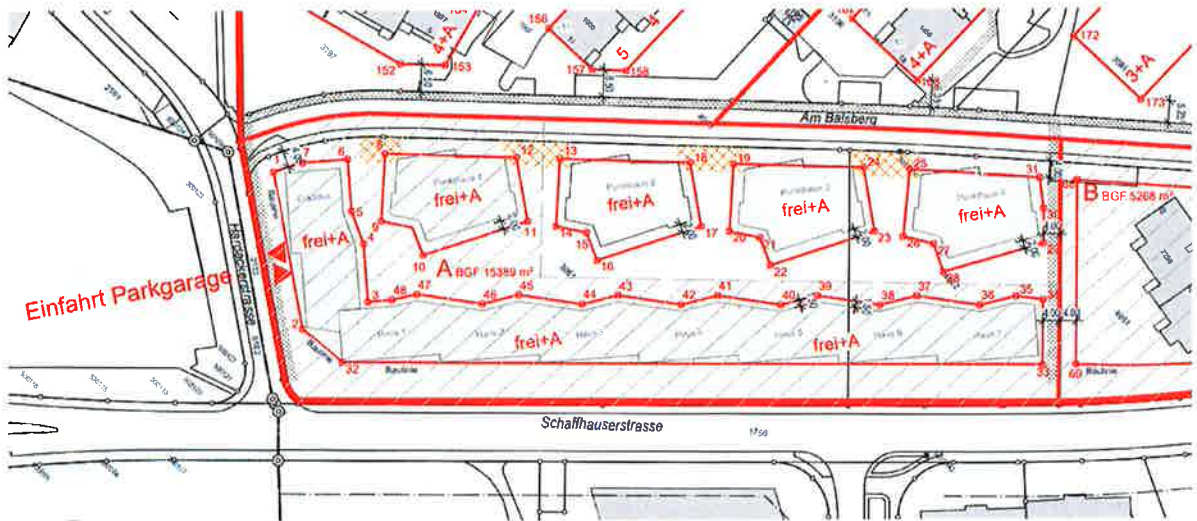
Ausschnitt privater Gestaltungsplan Balsberg, Sektor A
